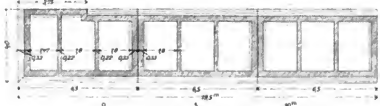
Grundrisse der Senkkasten der Pfeiler I-IV.
